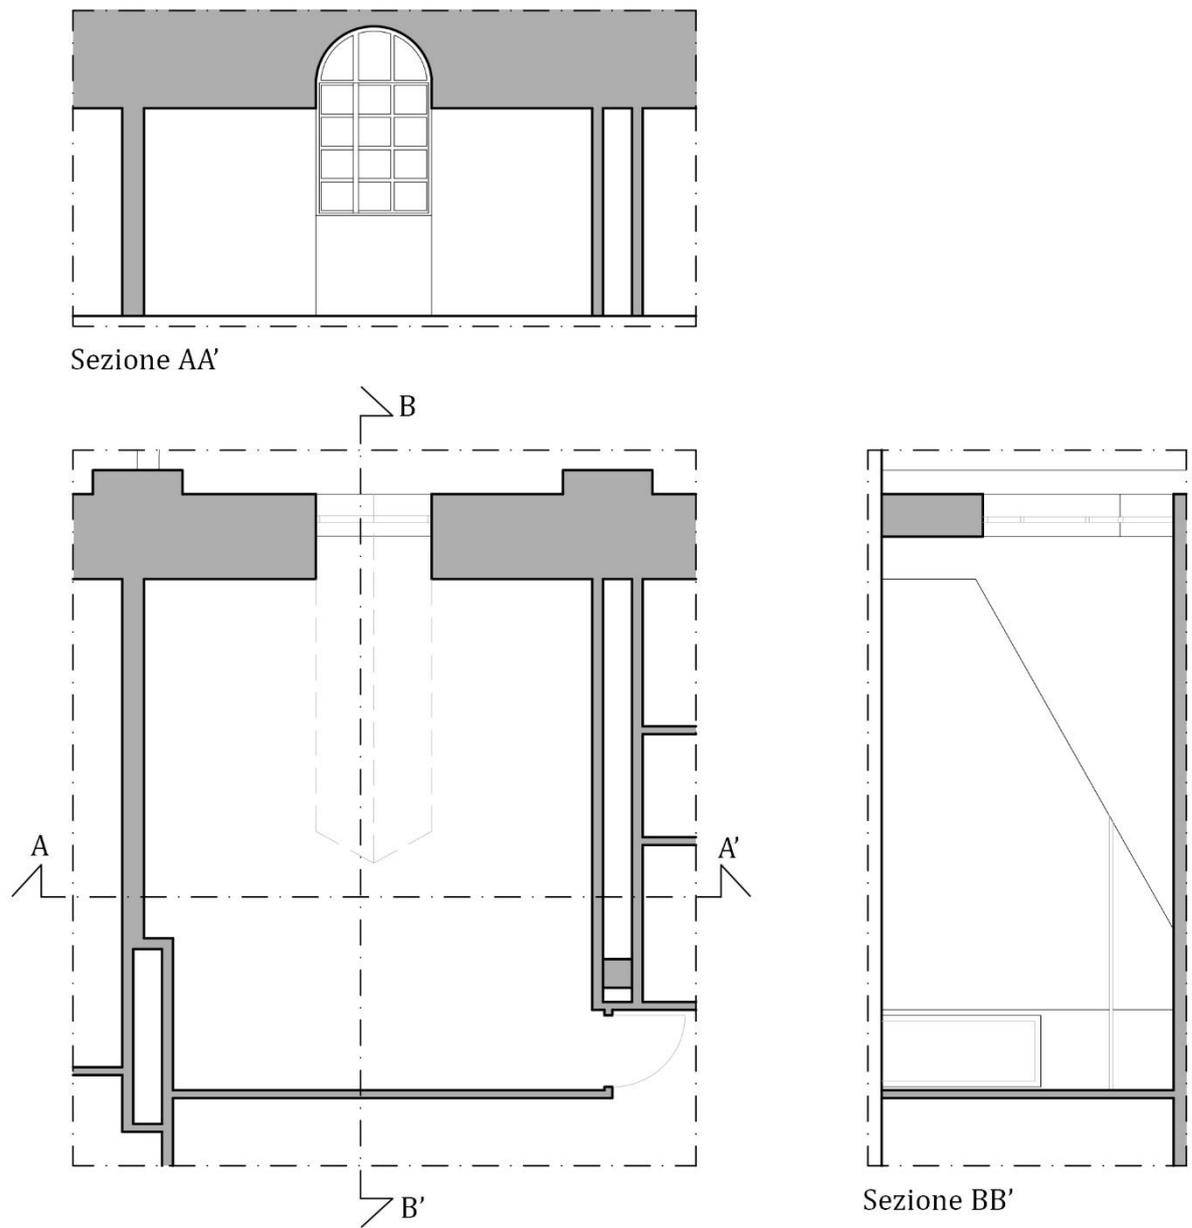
Pianta e sezioni in scala 1:100 del laboratorio di post-produzione, situato a nord-est del secondo piano.
